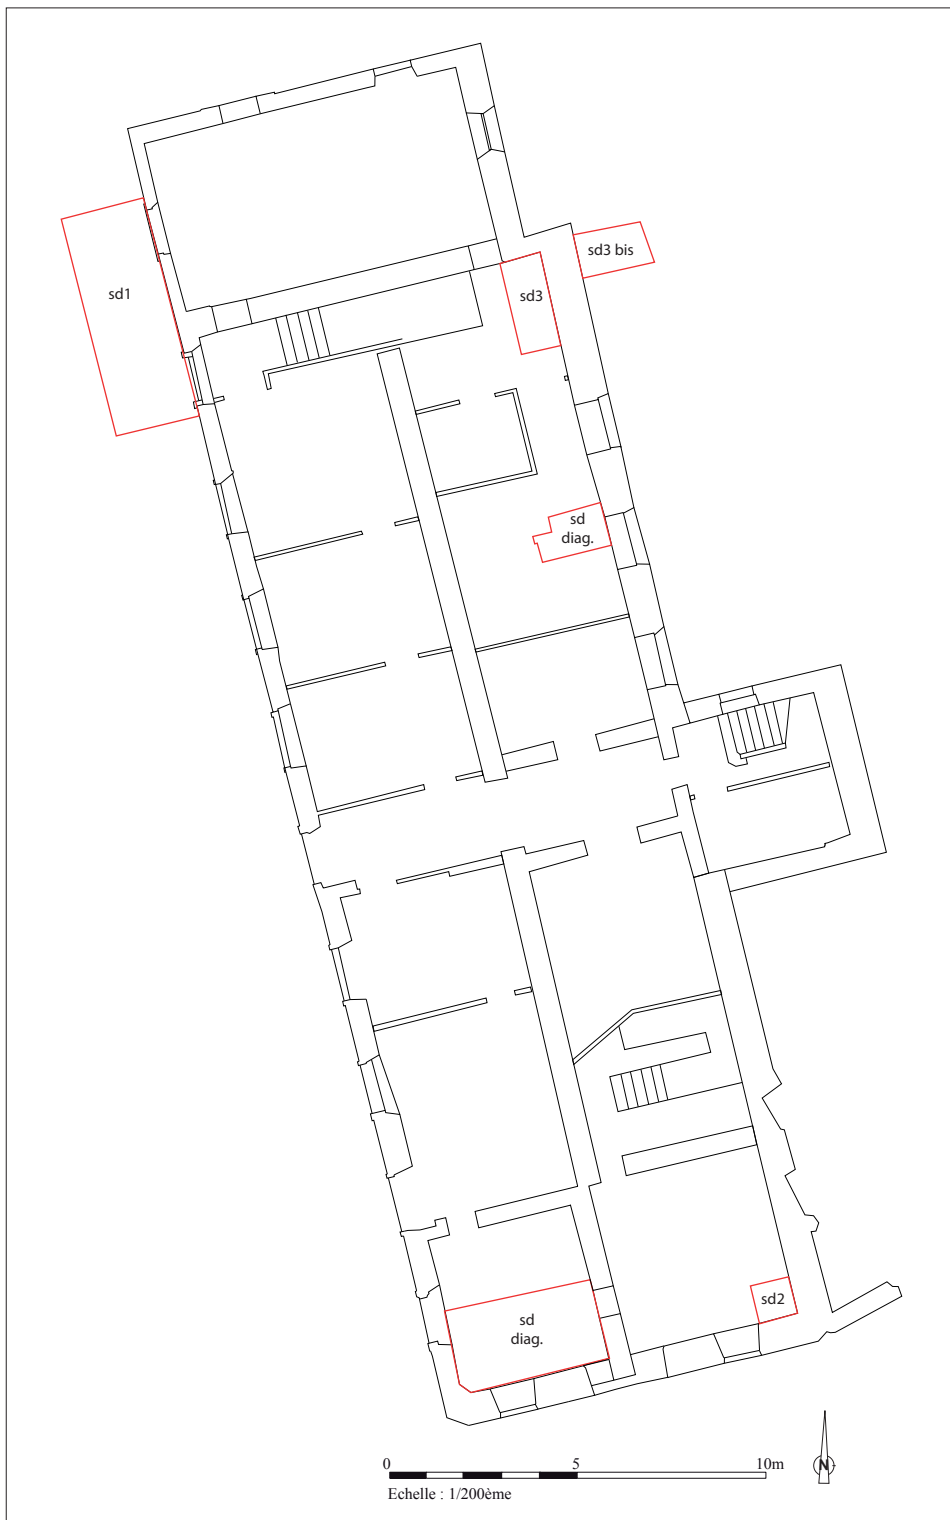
Le plan général avec l'implantation des sondages © Elen Esnault, Inrap
